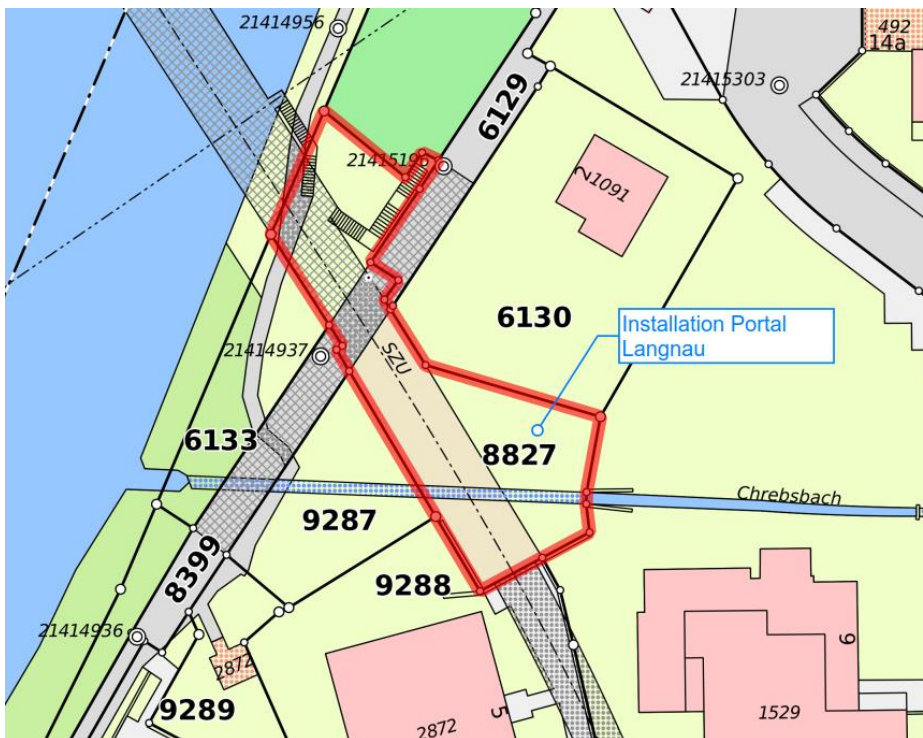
Grundstück SZU für Installation bei Portal Langnau
